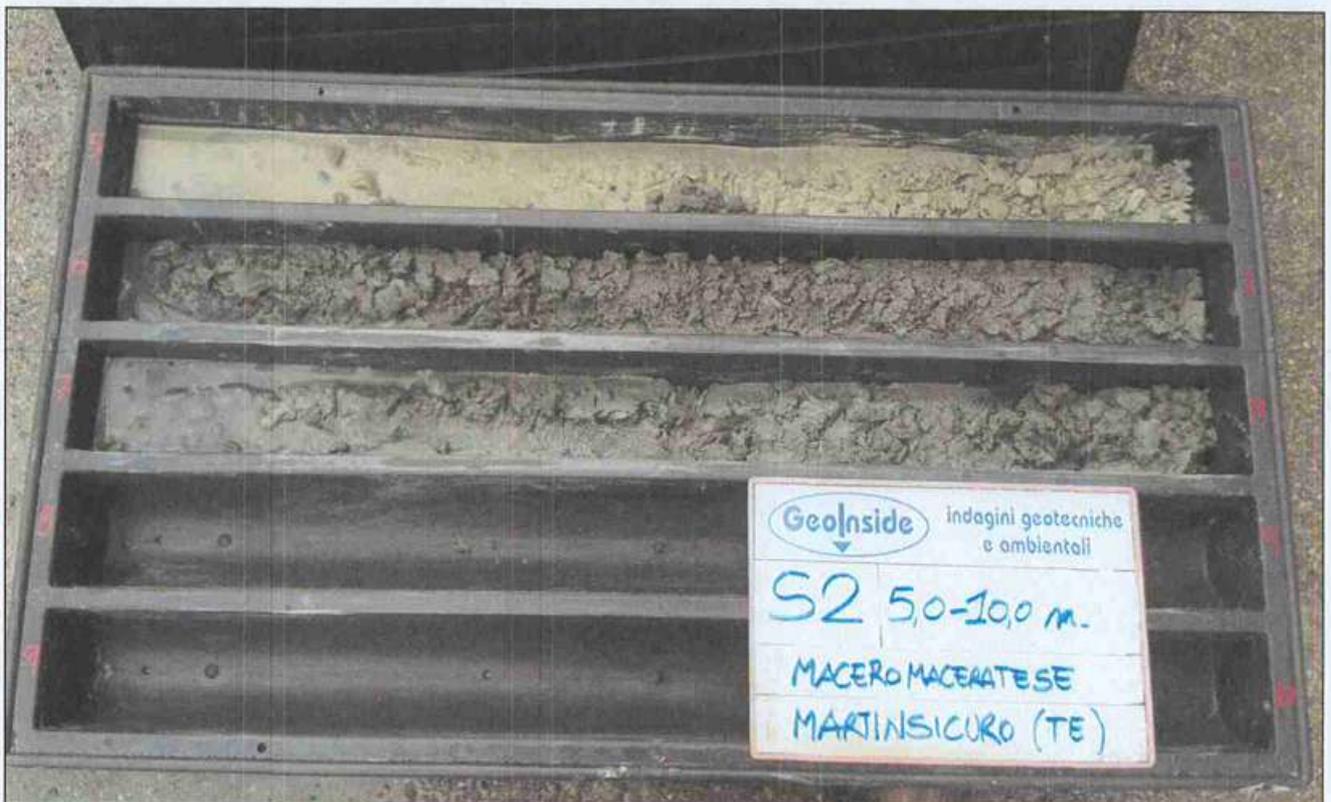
Cassetta del sondaggio S2 da 5,0 a 10,0 m.
